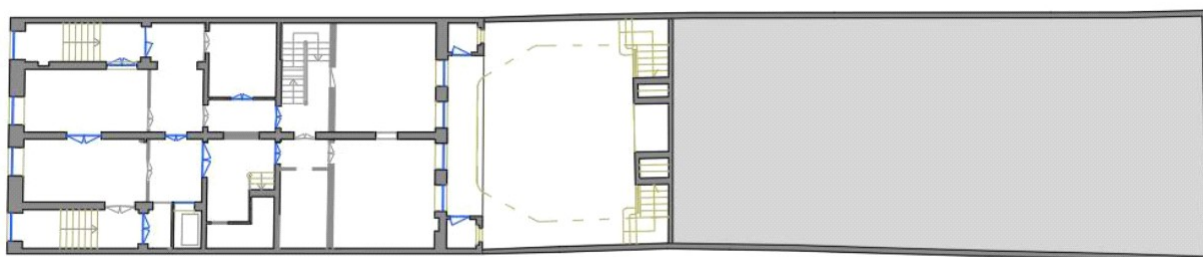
Planta de arquitetura original do piso 0 (sem escala)
